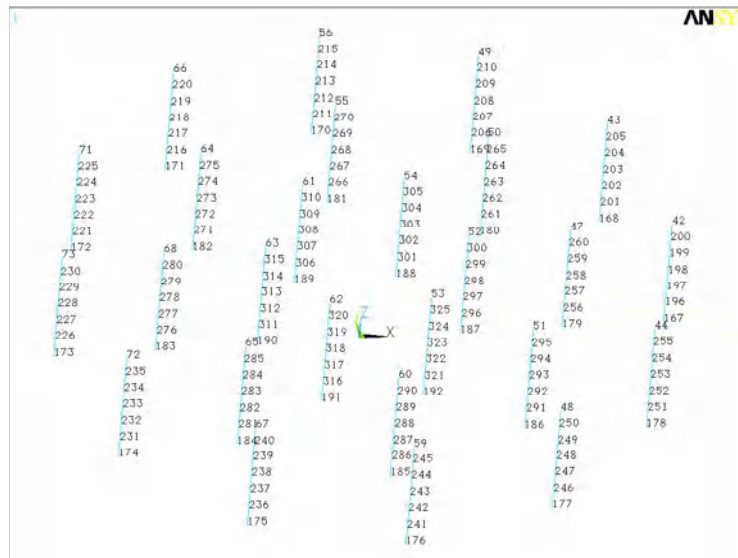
Modèle des poteaux support de la dalle (éléments poutres)
